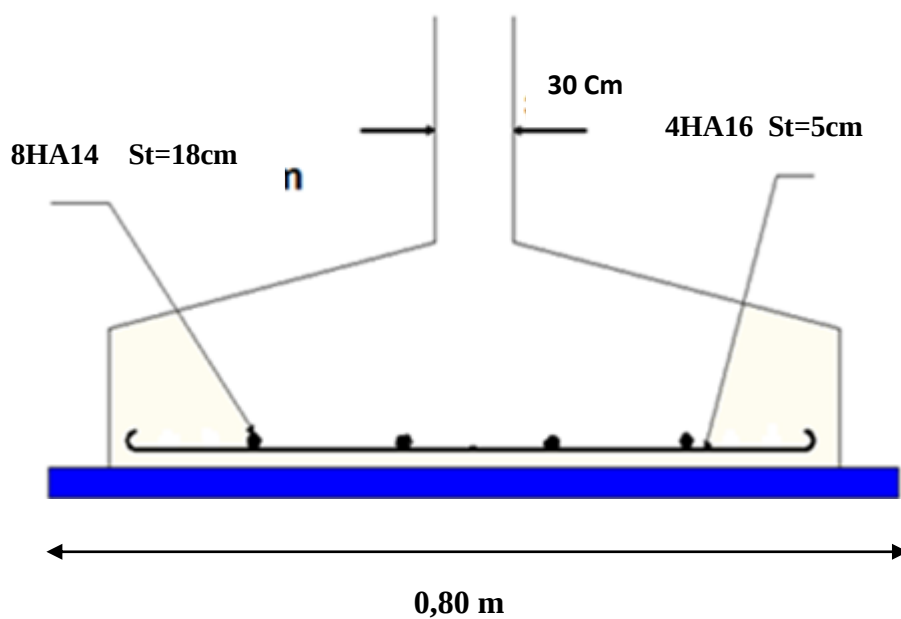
Schéma de ferrailage de la semelle du potelet
